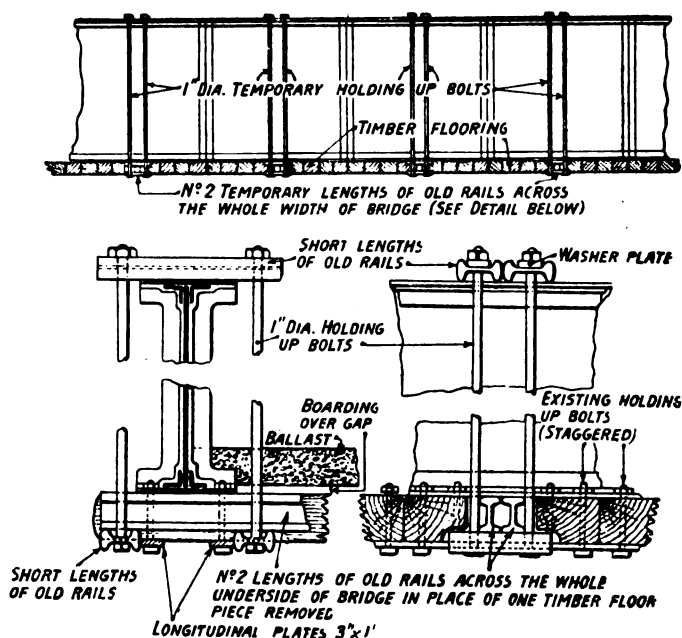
Metodo per il rafforzamento provvisorio del pavimento su travi di legno.
